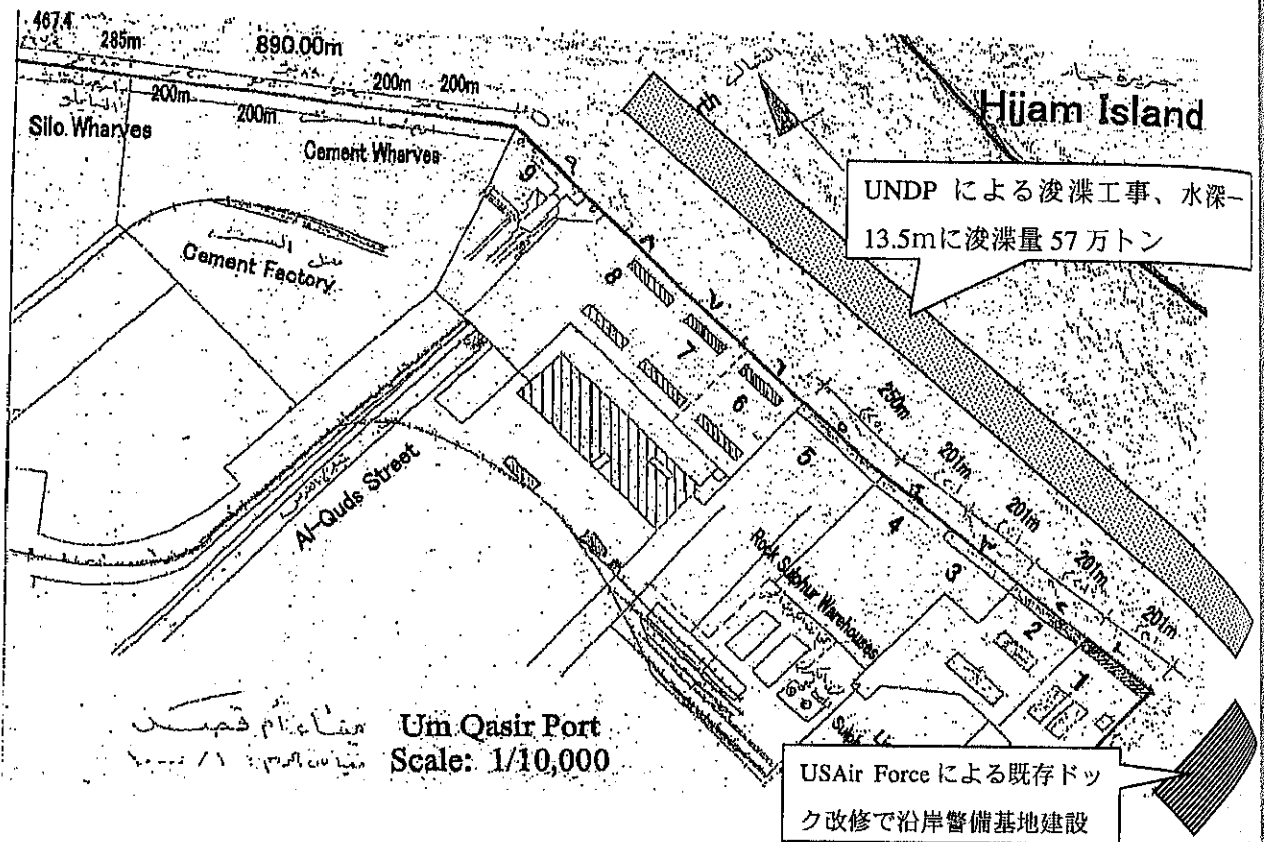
ウムカッスル港湾 旧港バース 1-9 平面図
